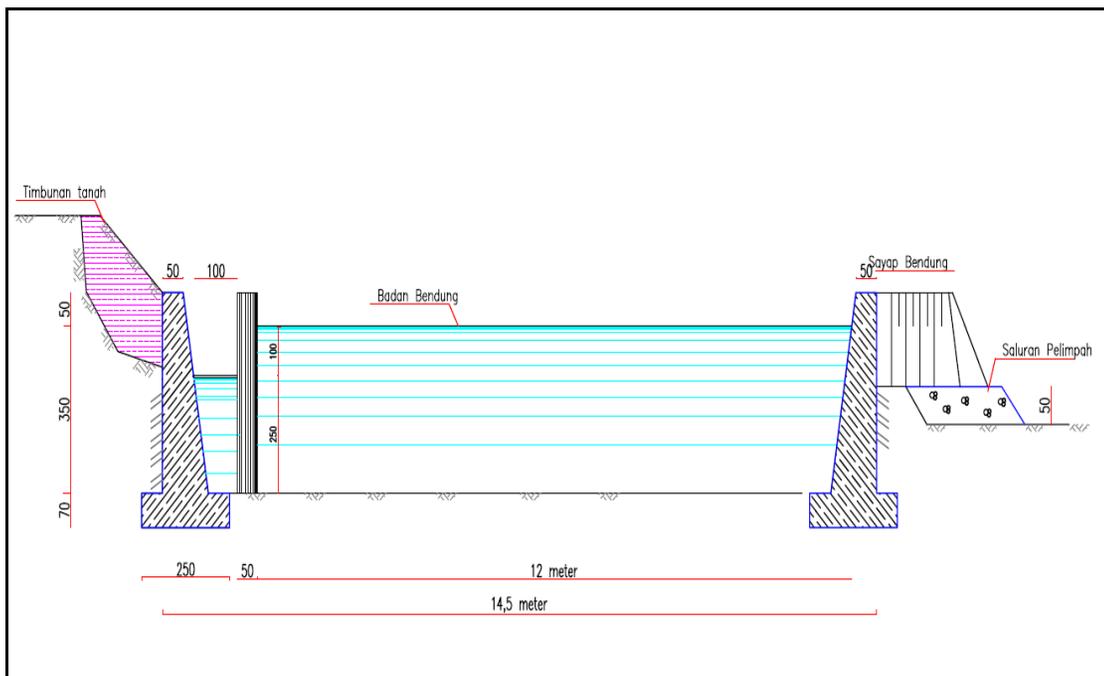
Bangunan Perlindungan Kanan Kiri/Tebing Sungai
